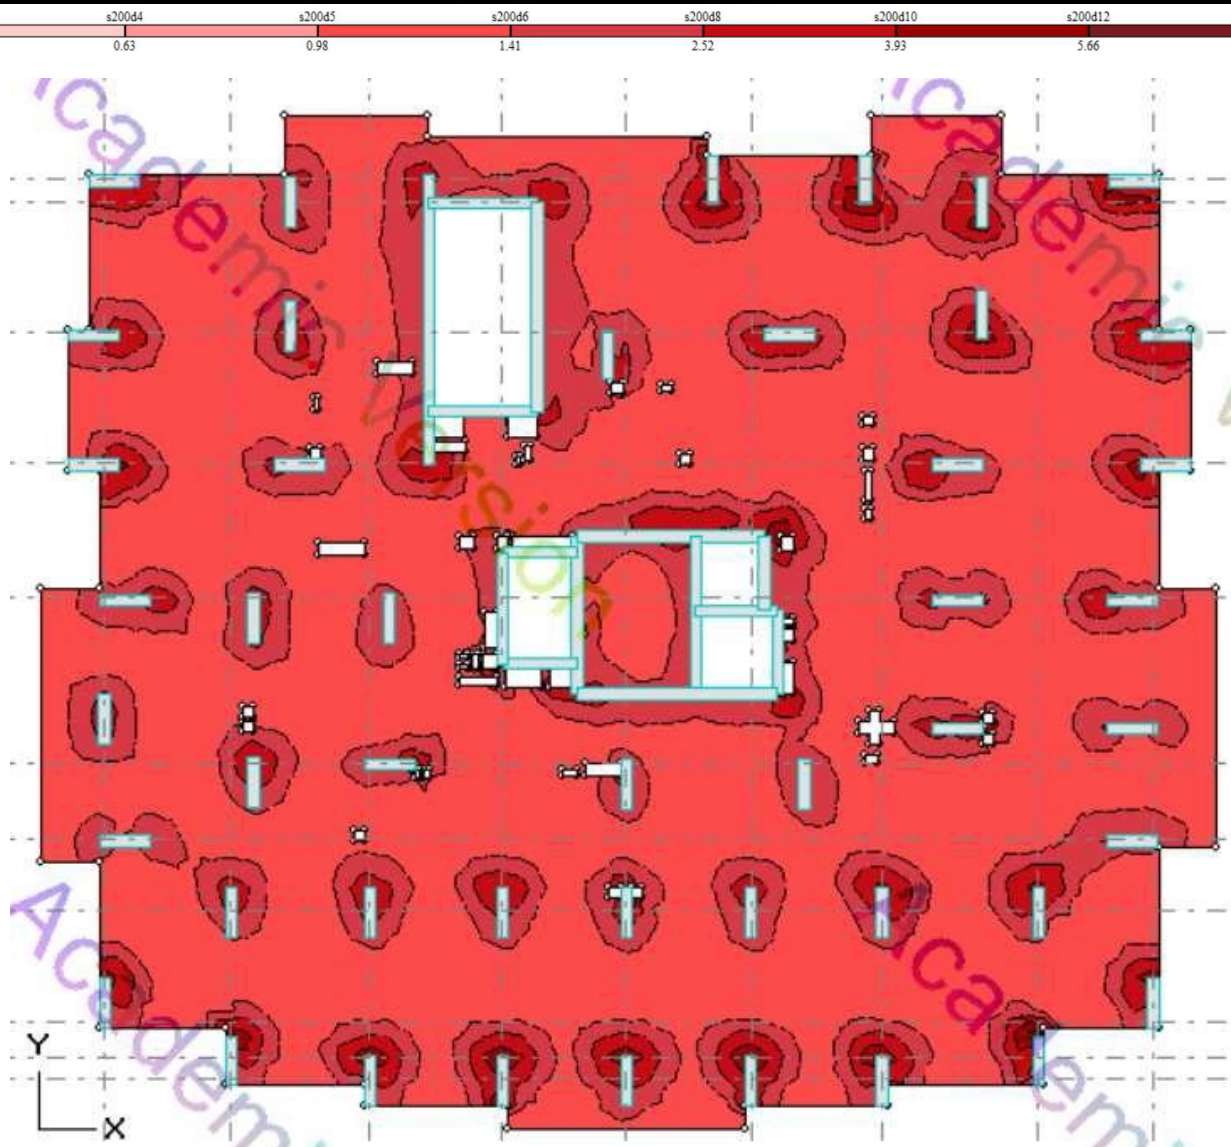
Арматура зони верхньої вздовж осі Y (A_v).
